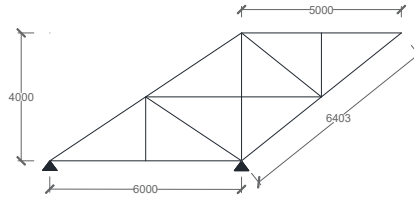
92 Ilustrasi Form Traveller yang Digunakan
